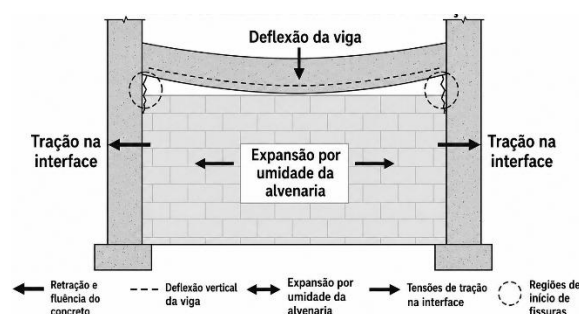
Mecanismo de incompatibilidade deformacional entre concreto armado e alvenaria de vedação.
